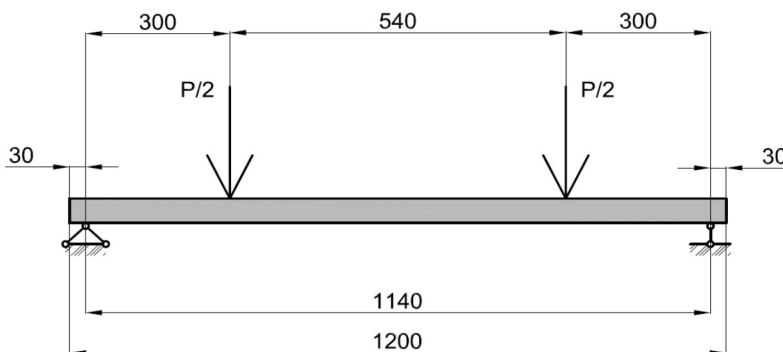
Схема випробування залізобетонних плит незнімної опалубки.
